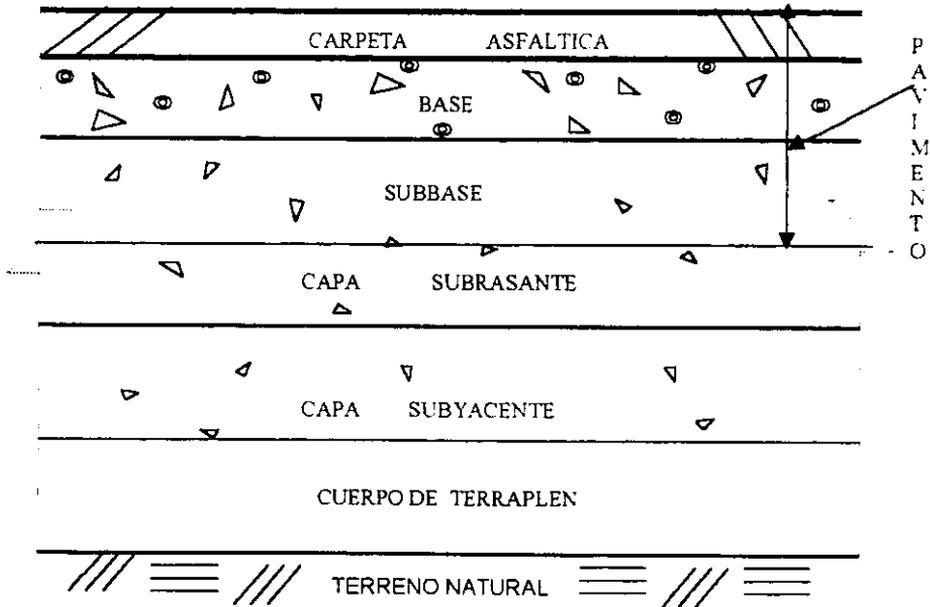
Sección Transversal en terraplén de una obra vial. Espesor del Pavimento
